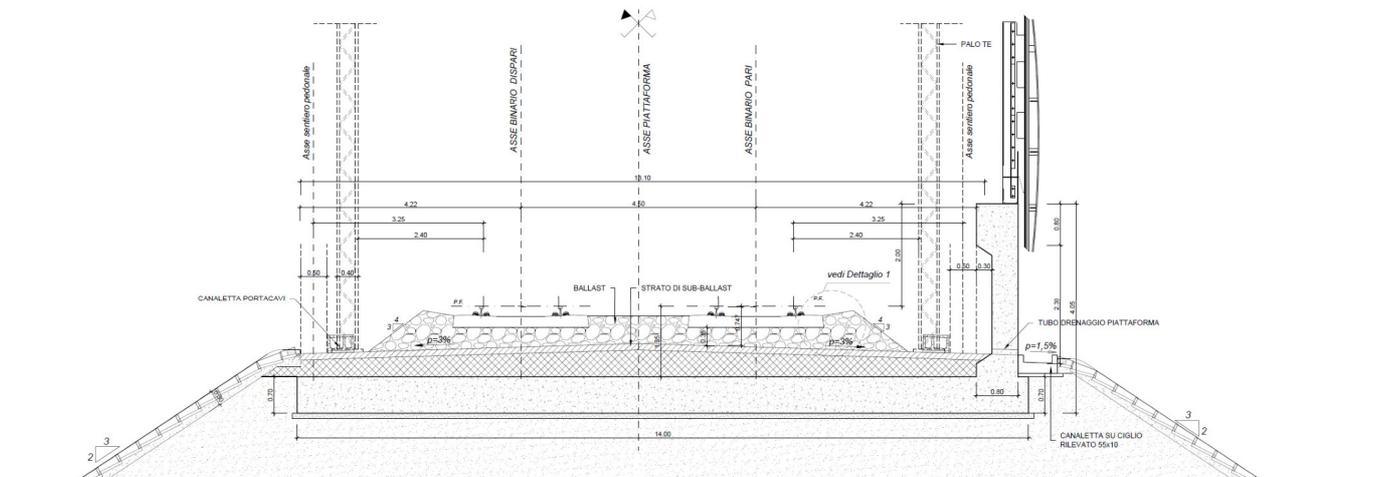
Sezione tipo in rilevato a doppio binario con muro di recinzione (tipo R01-B) con barriera antirumore
